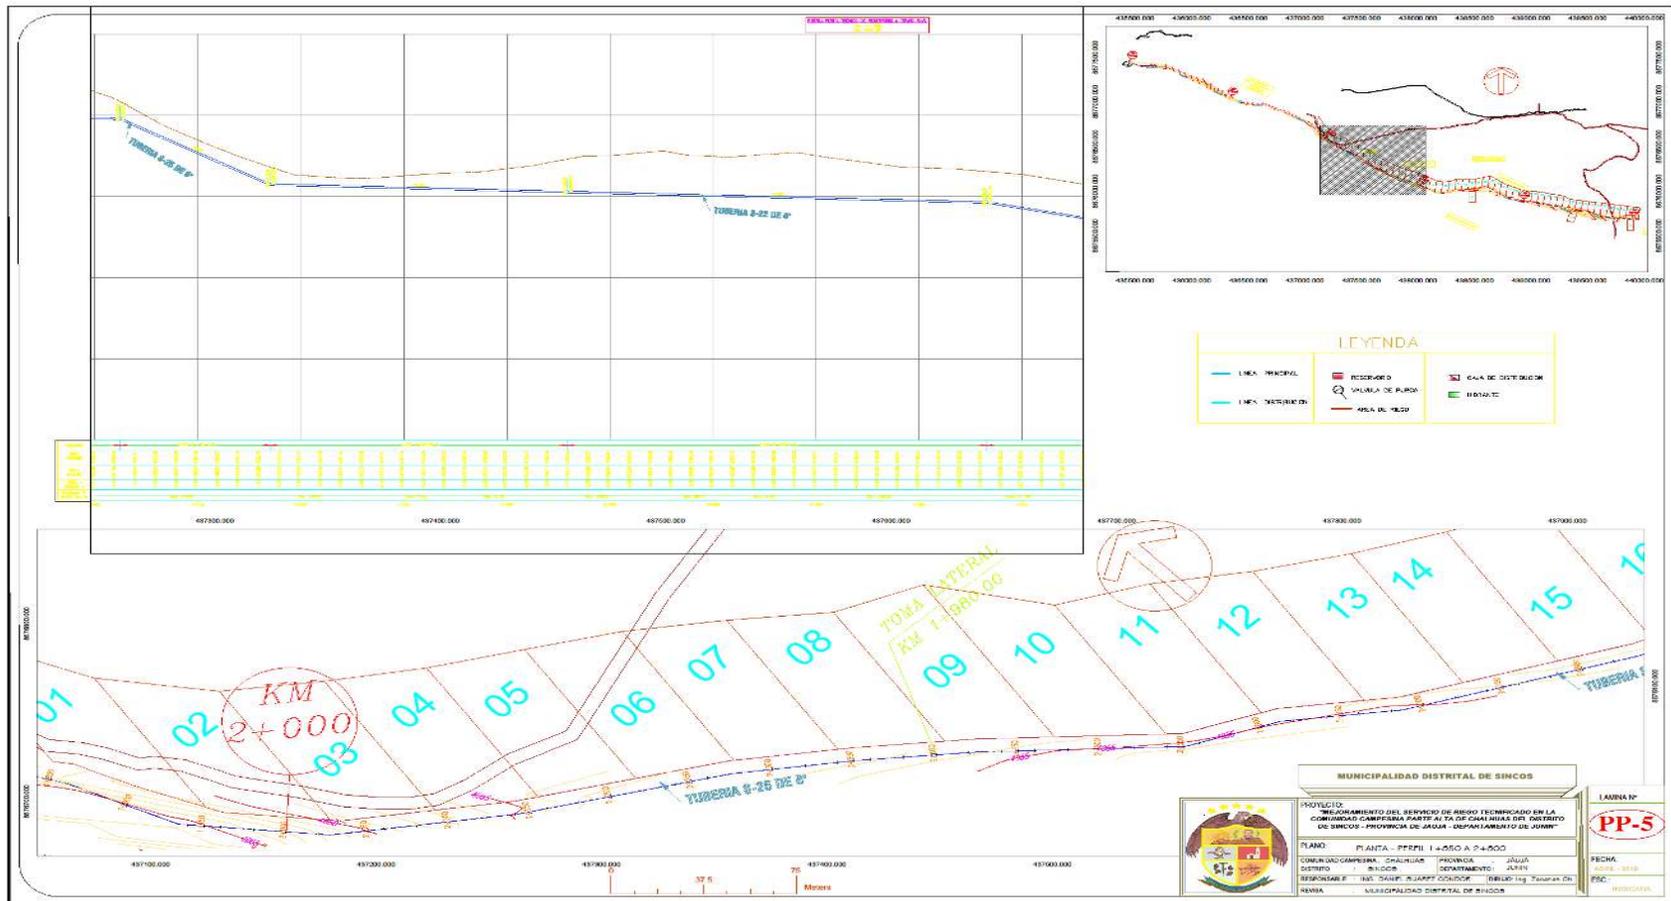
Plano de planta - perfil de canal Prog. 1+850 a 2+800.
